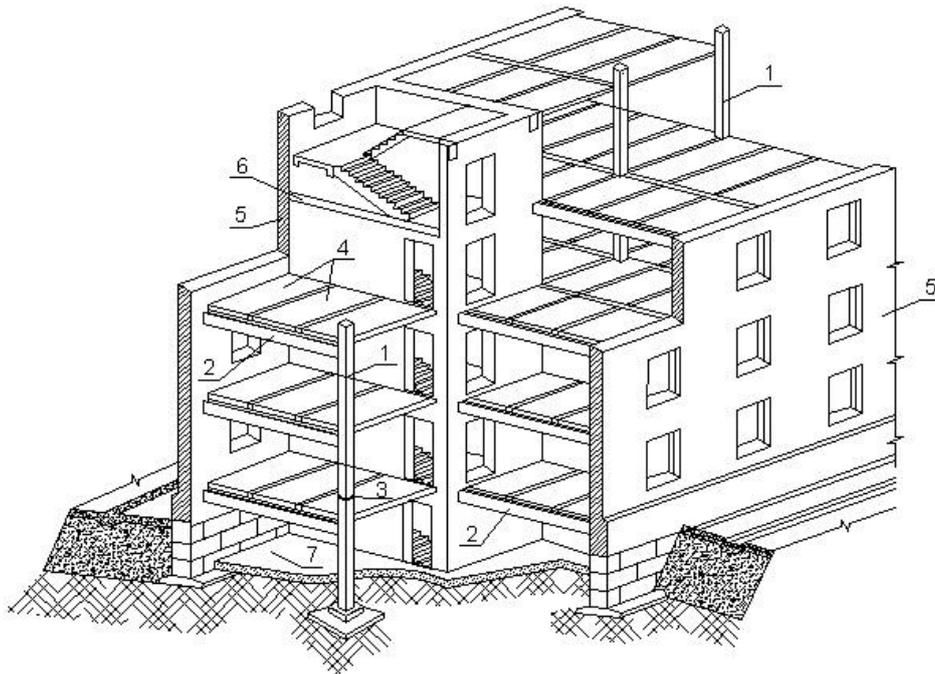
Будівля з внутрішнім каркасом (при одному ряді колон): 1 - колони; 2 - прогони; 3 - стик елементів колон; 4 - панелі перекриття; 5 - зовнішні несучі стіни; 6 - стіни сходової клітки; 7 - підлога підвального поверху.
